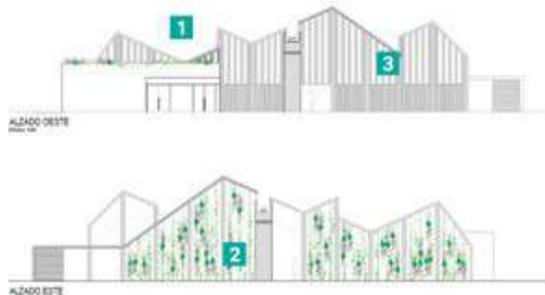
Zoco: técnicas de acondicionamiento. Fuente:Propia
